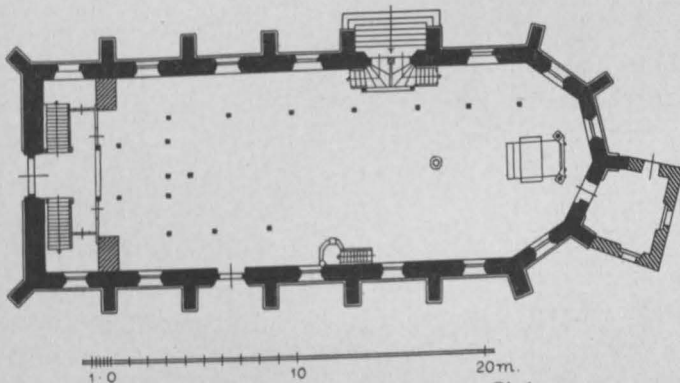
Sonnenwalde. Grundriß der Kirche.
